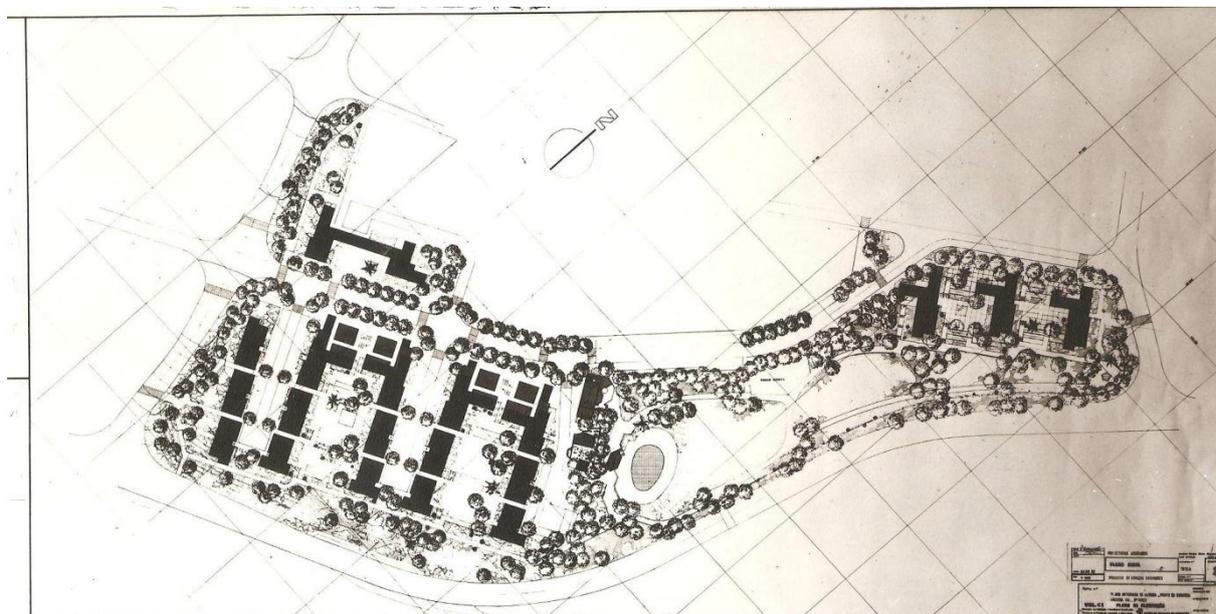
Plano Integrado de Almada – Monte da Caparica: Plano geral. 1980.
